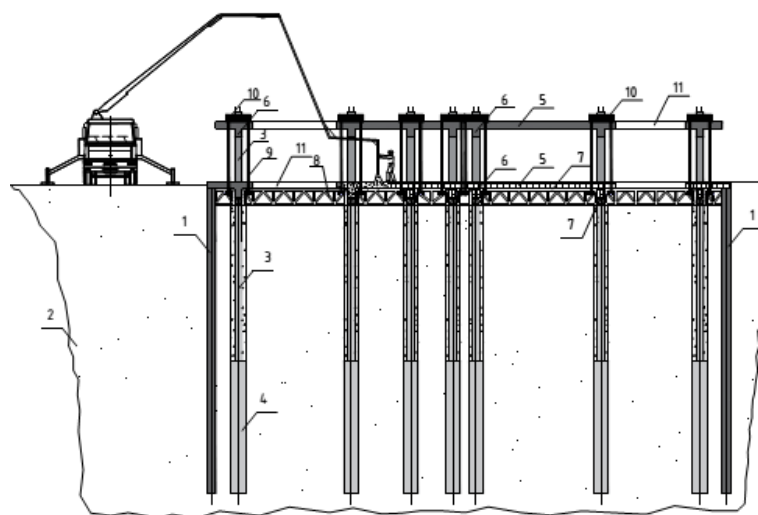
Технологический процесс бетонирования перекрытия будущей подземной части многоэтажного железобетонного каркаса на нулевой отметке
